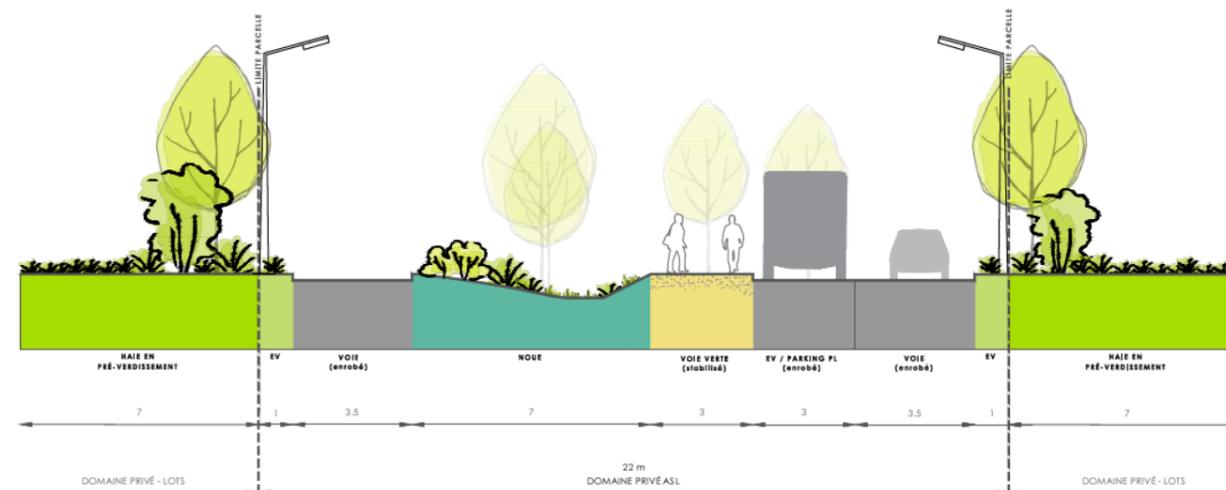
MAIL PAYSAGER - COUPE EE'
